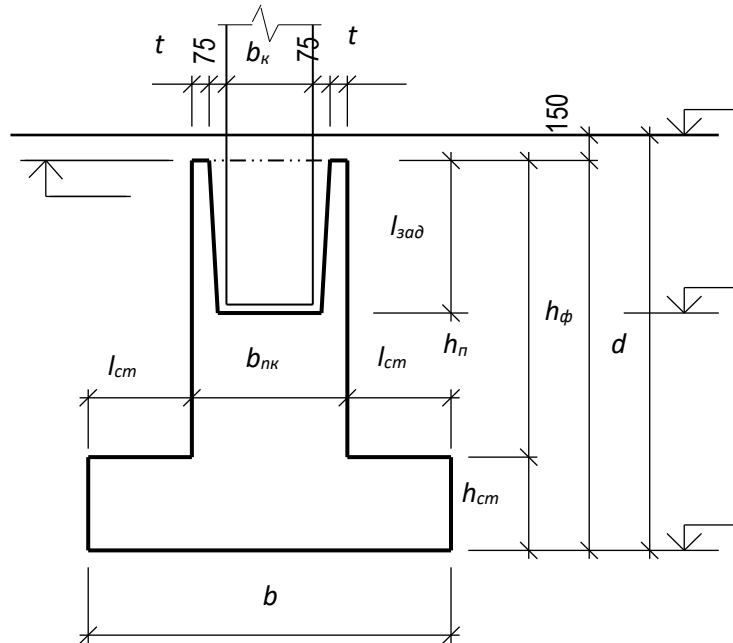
Попереднє конструювання окремого монолітного залізобетонного фундаменту під колону
